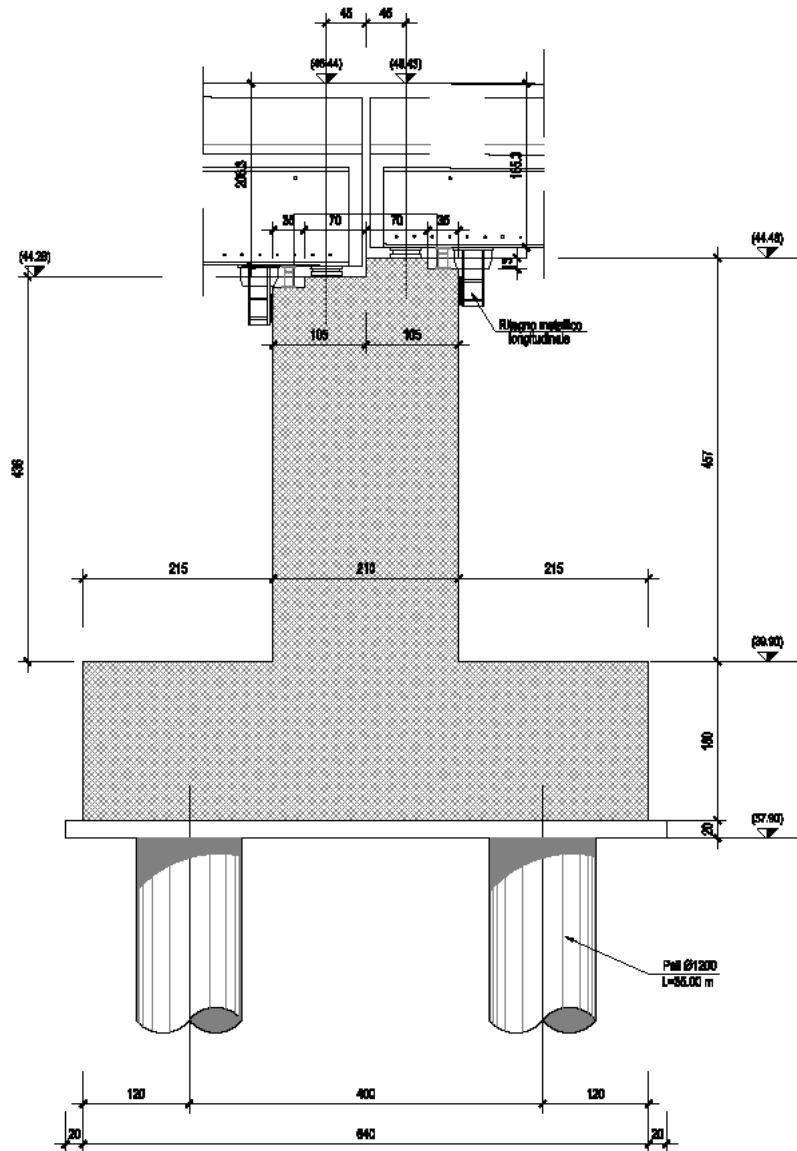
Pila, prospetto longitudinale – Due impalcati a travi incorporate
